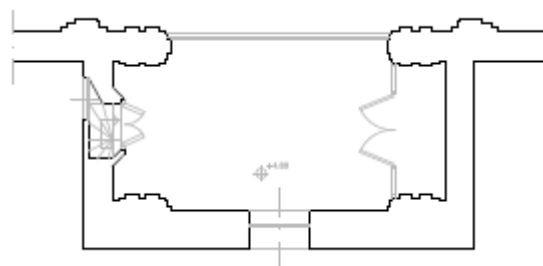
Plano de Entreplanta. Fuente: Universidad de Sevilla
